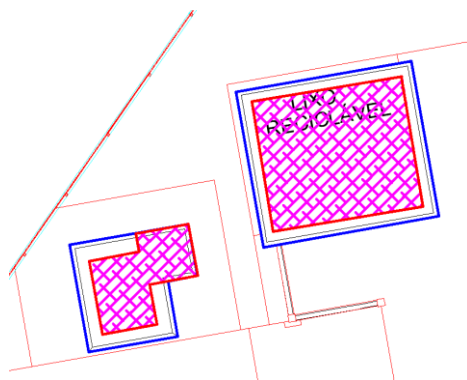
Áreas consideradas para o pavimento em contato com a fundação (Guarita 1 e Lixo)
